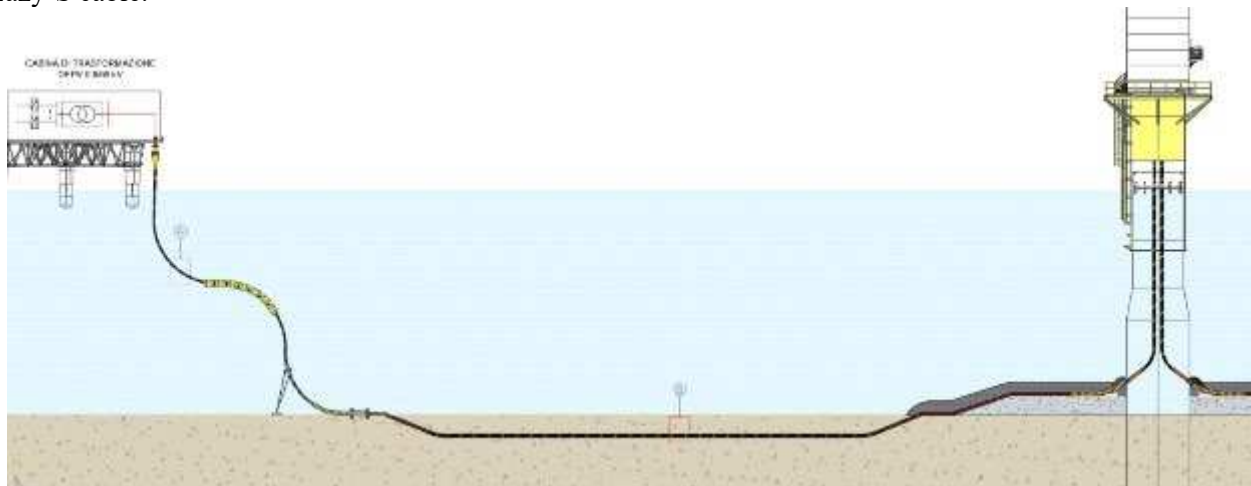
Collegamento Lazy-S con posa su fondale con protezione mediante massi naturali
